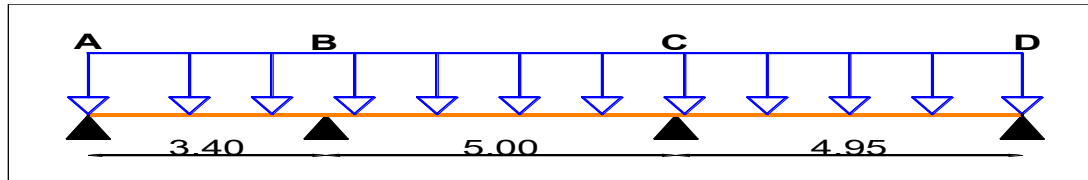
Schéma statique de la poutrelle type 02(étage courant).
